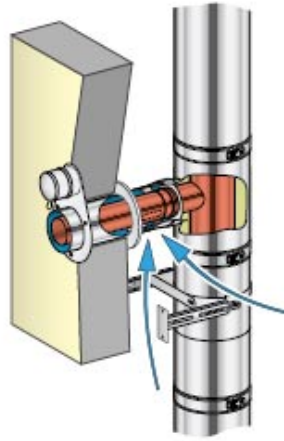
Mise en place des conduits de liaison, 3CE P MULTI+ à l'extérieur d'un bâtiment
